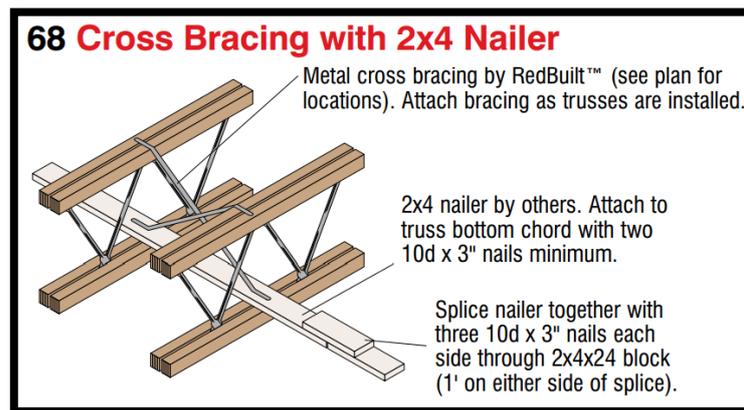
Detalle Cross Bracing. Fuente: RedBuilt Engineered Wood Products.
